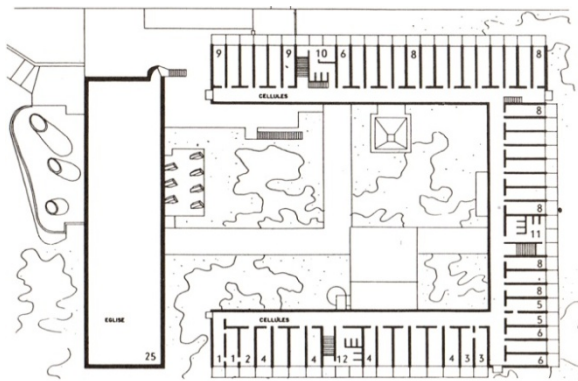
Planta tipo Convento Sainte-Marie-de-la-Tourette
